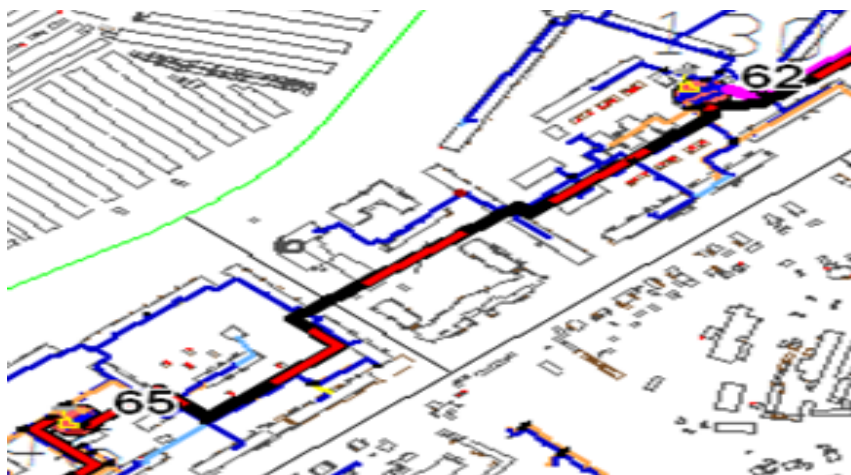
Схема прокладки трубопровода между котельными №62 и №65
